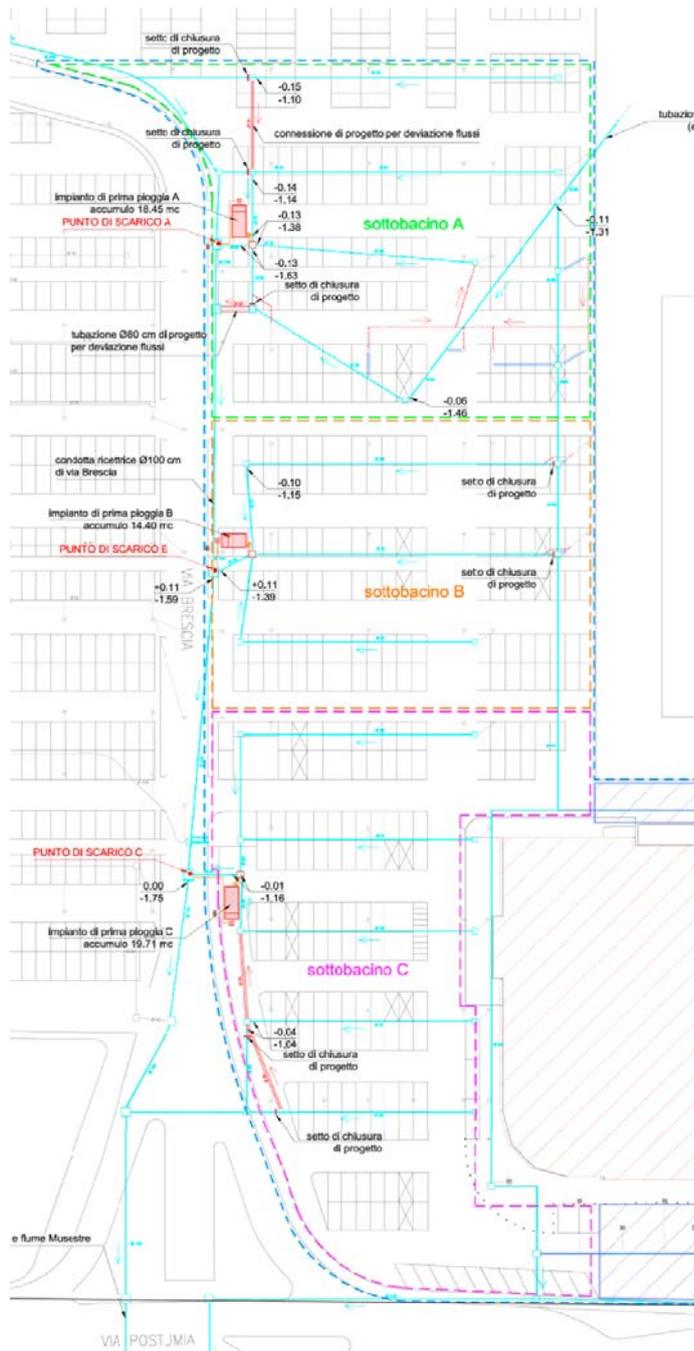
Schema di collegamento e posizionamento dei manufatti di trattamento.
